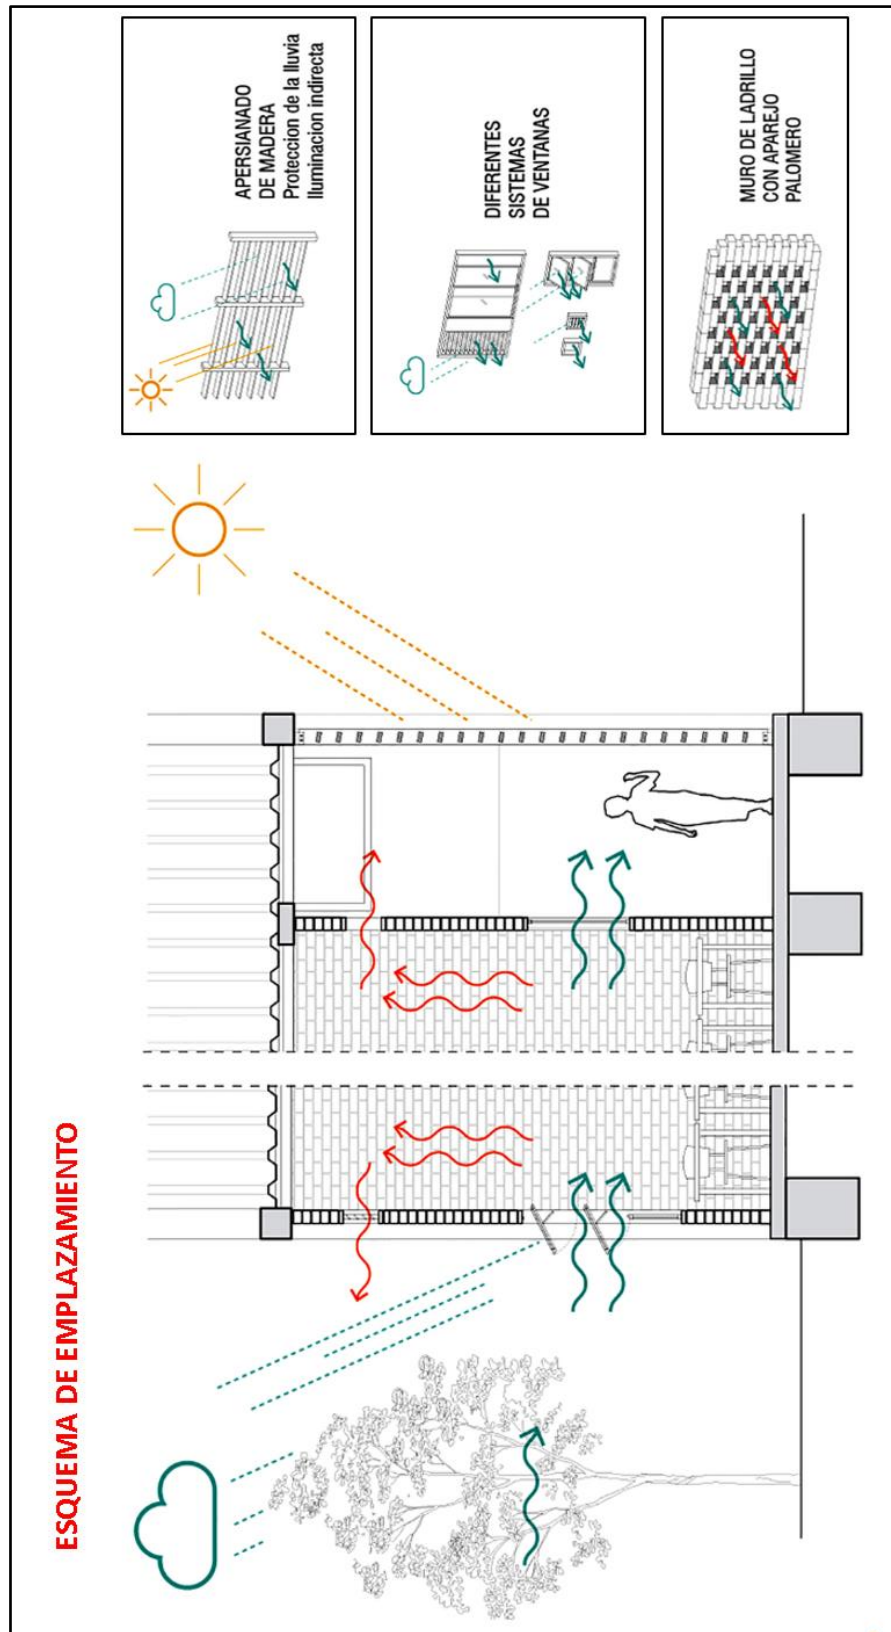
Sistema Constructivo de la escuela secundaria Santa Elena.
